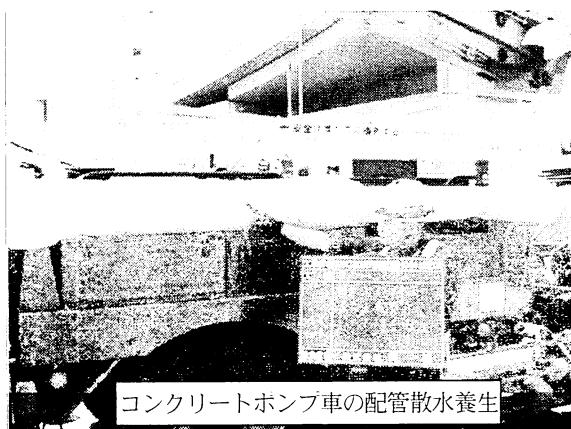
生コンクリート圧送時の温度上昇防止対策実施状況
